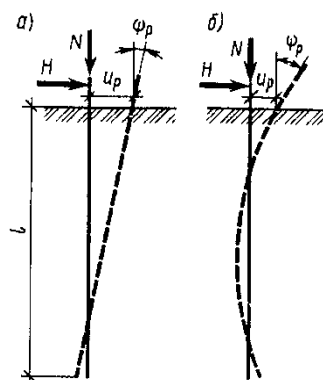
Схемы работы горизонтально нагруженных свай
